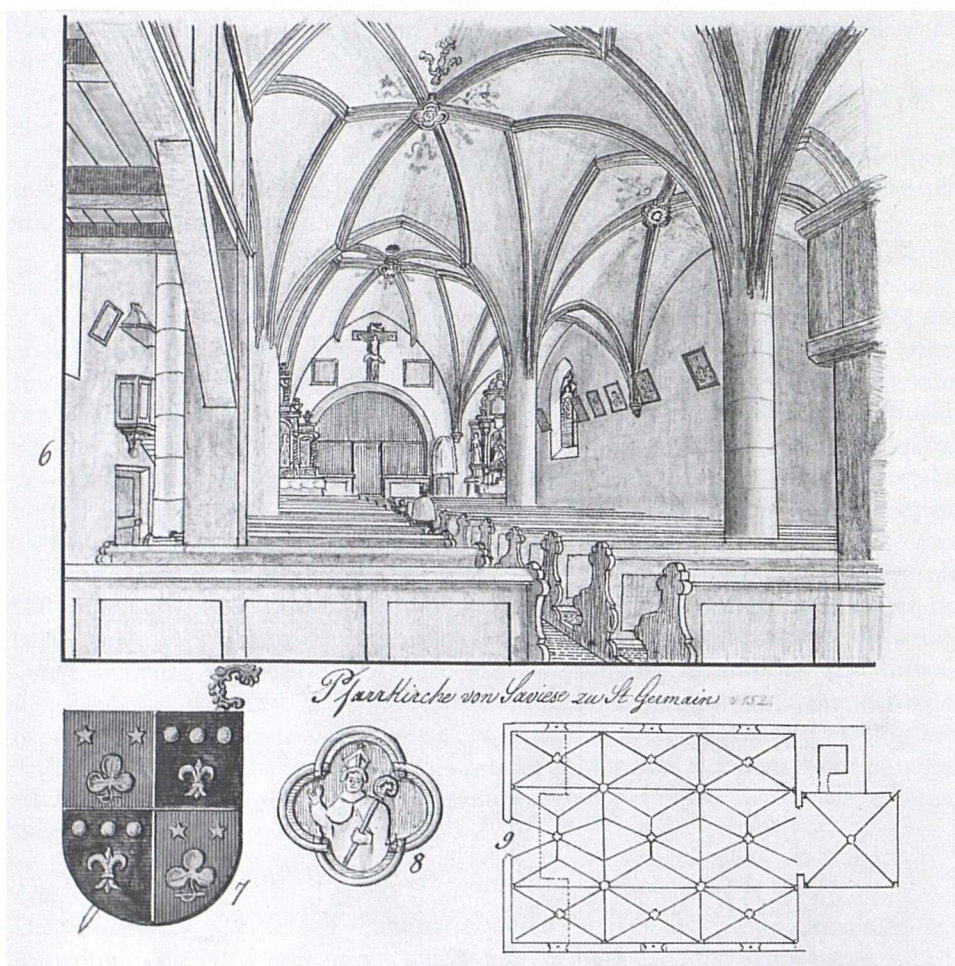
Savièse, Kirche, innen und Grundriss / Savièse, église, intérieur et plan.
